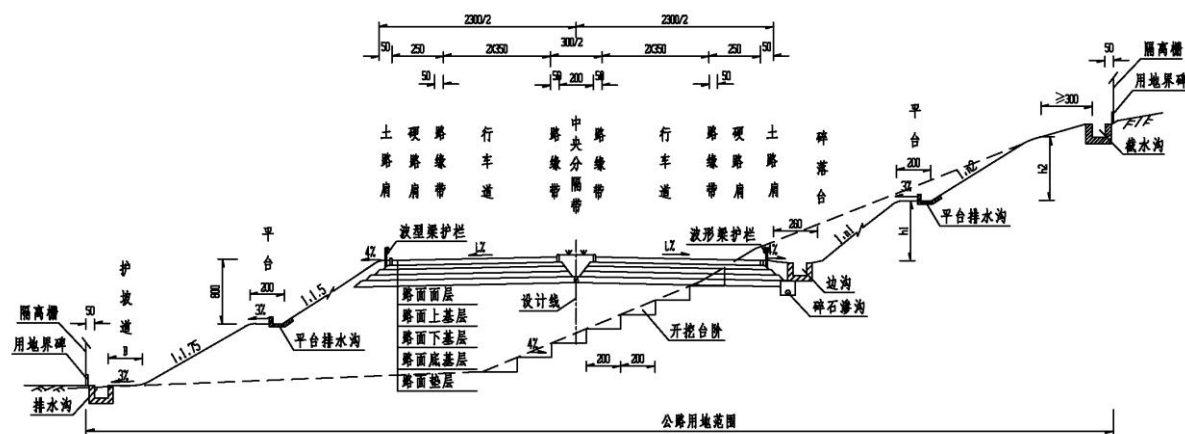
互通立交连接线路基标准横断面图 单位: cm
